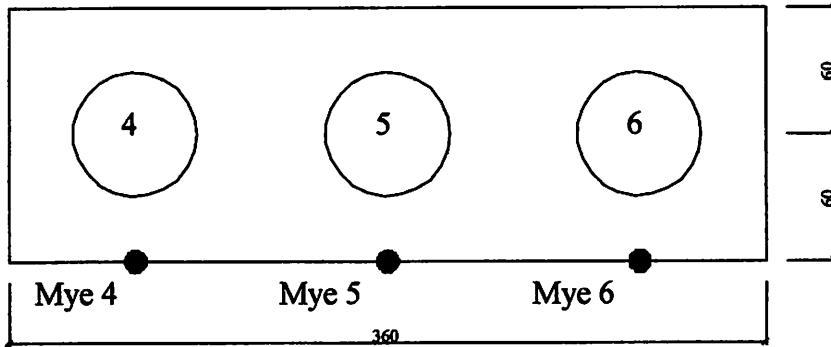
Arah pembebanan pondasi tiang bor pada poer Tipe 2(6 tiang)
